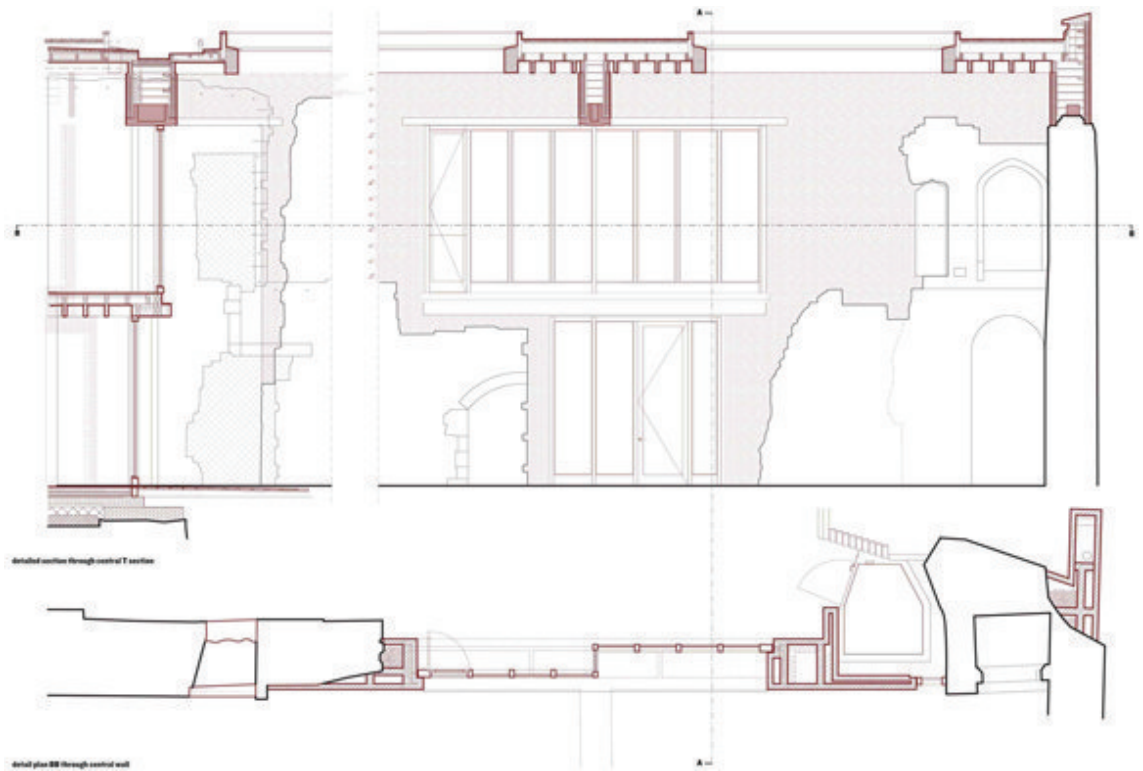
Dettaglio di progetto in prospetto e in pianta (tratto da: www.architectural-review.com).
